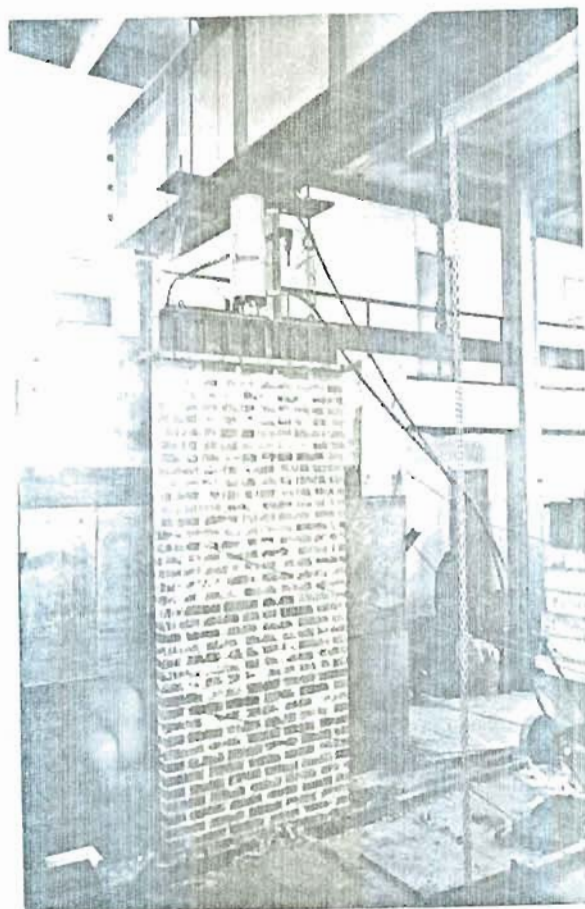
Detalhe do prtico de reao e equipamento utilizado no rompimento das paredes.
